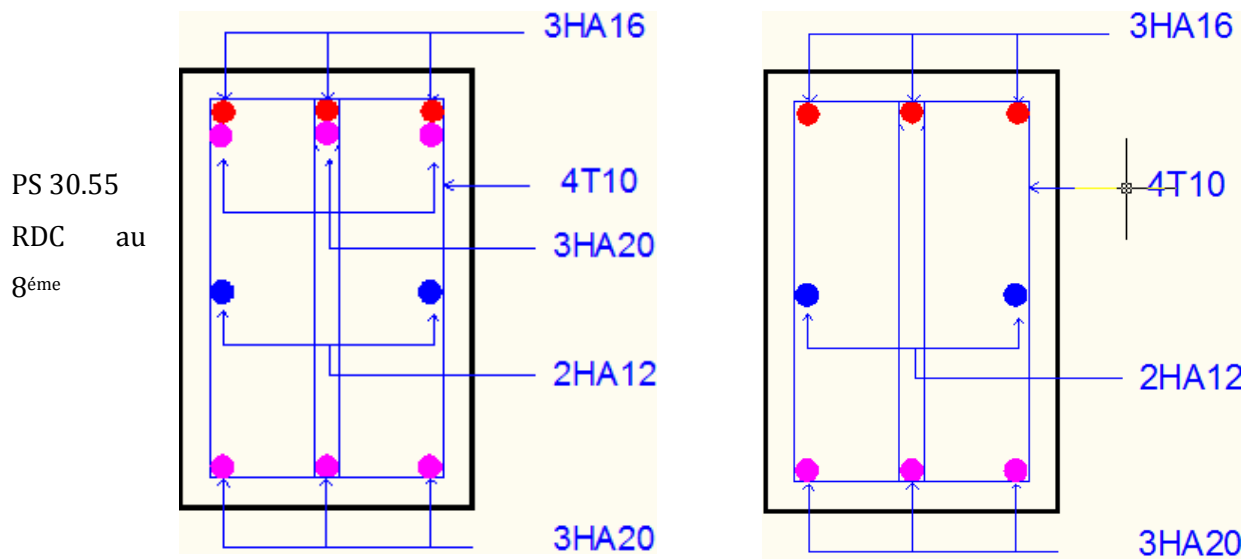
Section de ferrailage des poutres secondaire RDC au 4<sup>ème</sup>.
